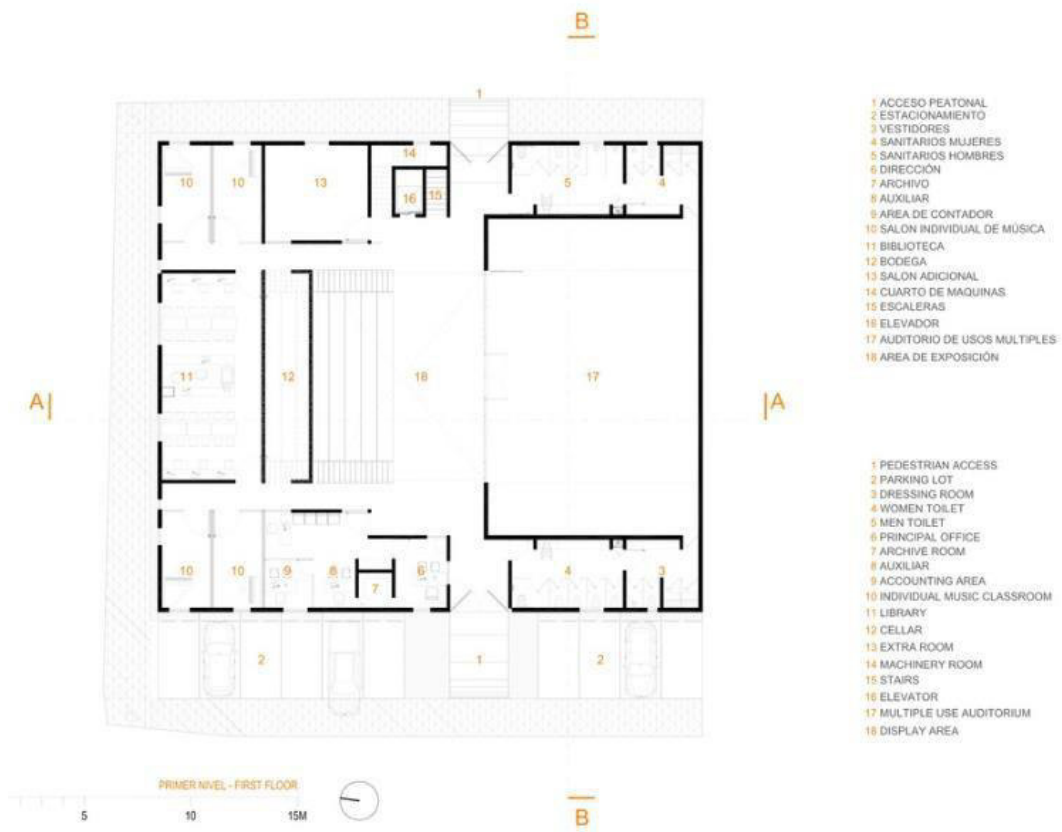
Planta Arquitectónica Primer Nivel. Archdaily 2017.
